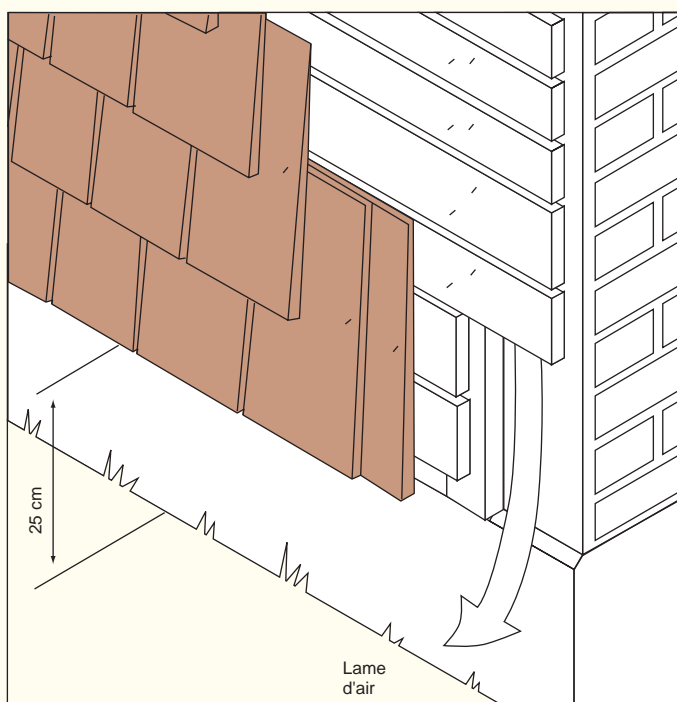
Détails de pose de shingles de 400mm sur un mur en maçonnerie
